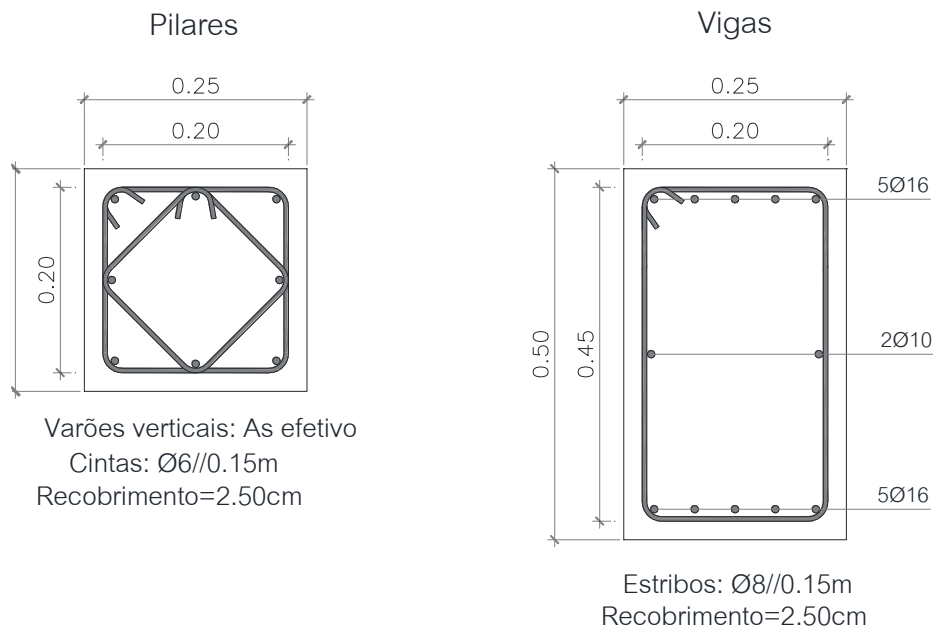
Pormenorização de pilares e vigas dos exemplos 5 e 6
